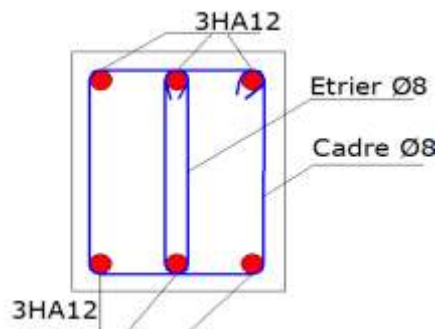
Schéma de ferrailage des poutres secondaires en travées et aux appuis
